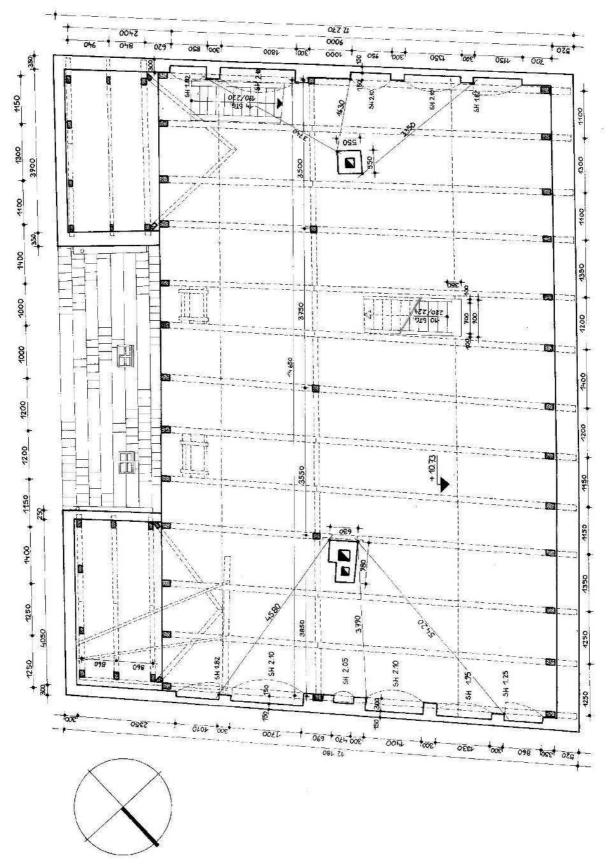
Webergasse 1, Grundriss des Dachgeschosses Vermessung
